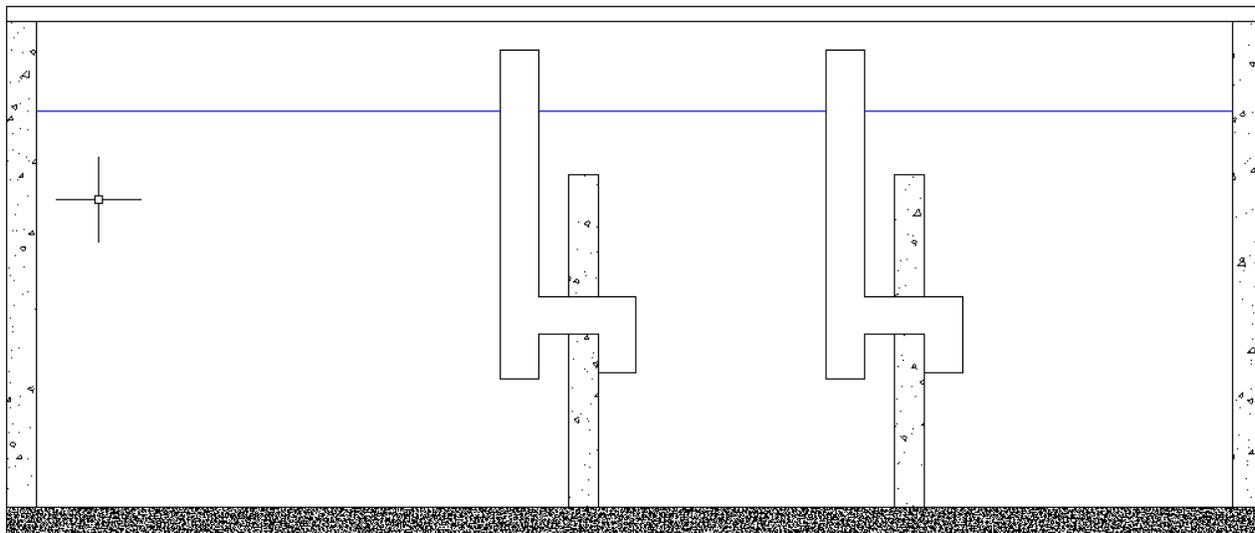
Trampa de grasa Italcol planta 1 vista perfil
